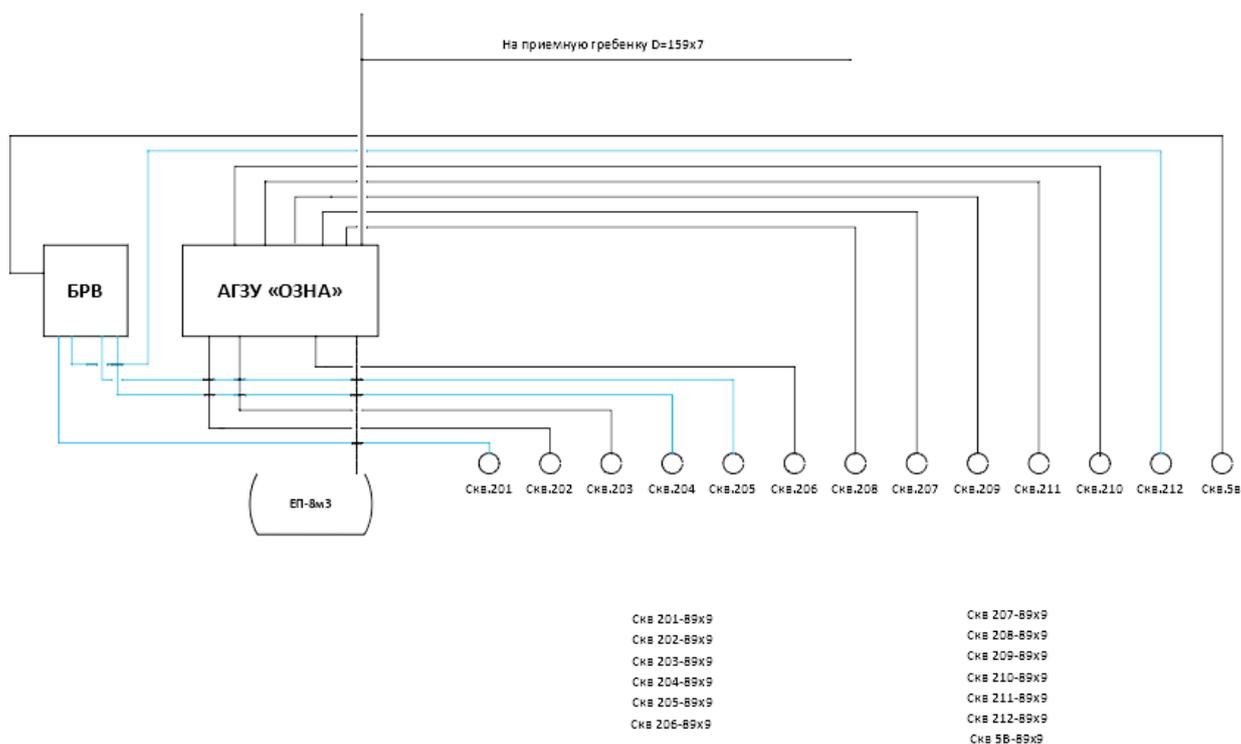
Схема внутриплощадных трубопроводов куста №2 X месторождения
